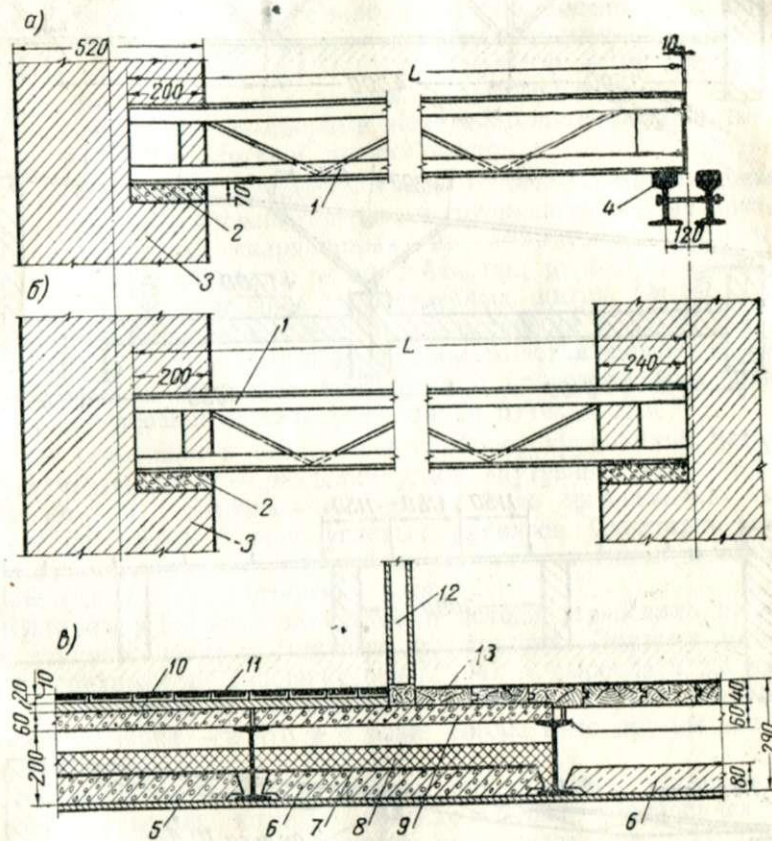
Прутковые детали сводных прогонов для междуэтажных перекрытий: а — опирание на прогон с заделкой в стену; б — заделка в обе стены; в — сопряжение различных конструкций перекрытий; 1 — металлический сварной прогон; 2 — бетонная подушка; 3 — стена; 4 — прогон; 5 — штукатурка; 6 — нижние сборные железобетонные плиты; 7 — изоляционный картон или промазка битумом; 8 — шлак 50 мм; 9 — верхние сборные железобетонные плиты; 10 — цементная стяжка; 11 — метлахский пол; 12 — сборная деревянная перегородка; 13 — деревянный пол
